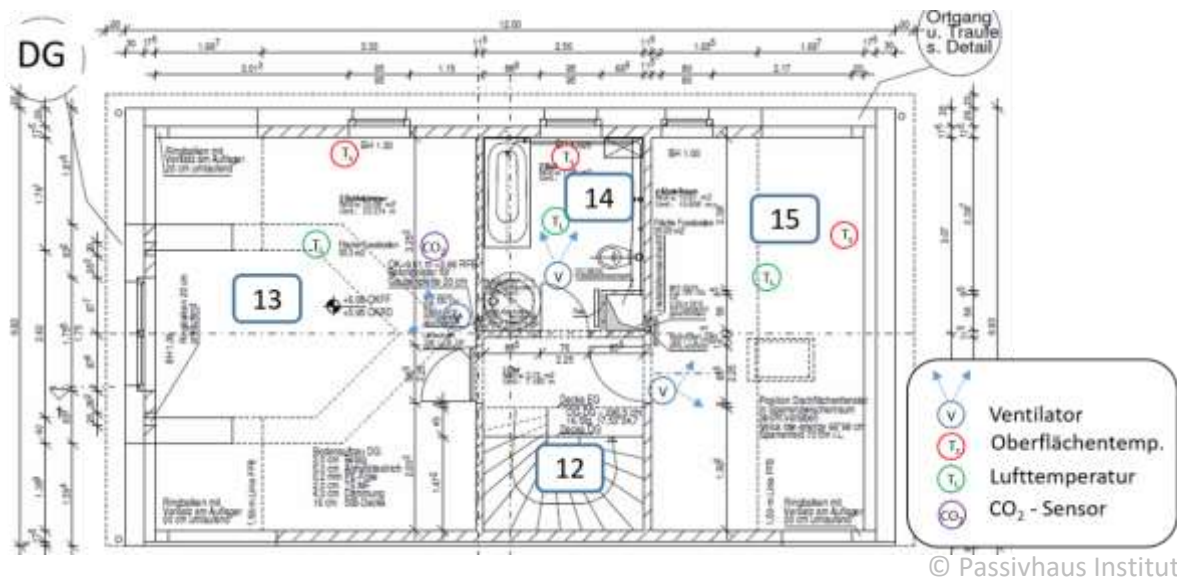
Grundriss mit Zonenzuordnung und Sensorpositionen für das Dachgeschoss (DG).
